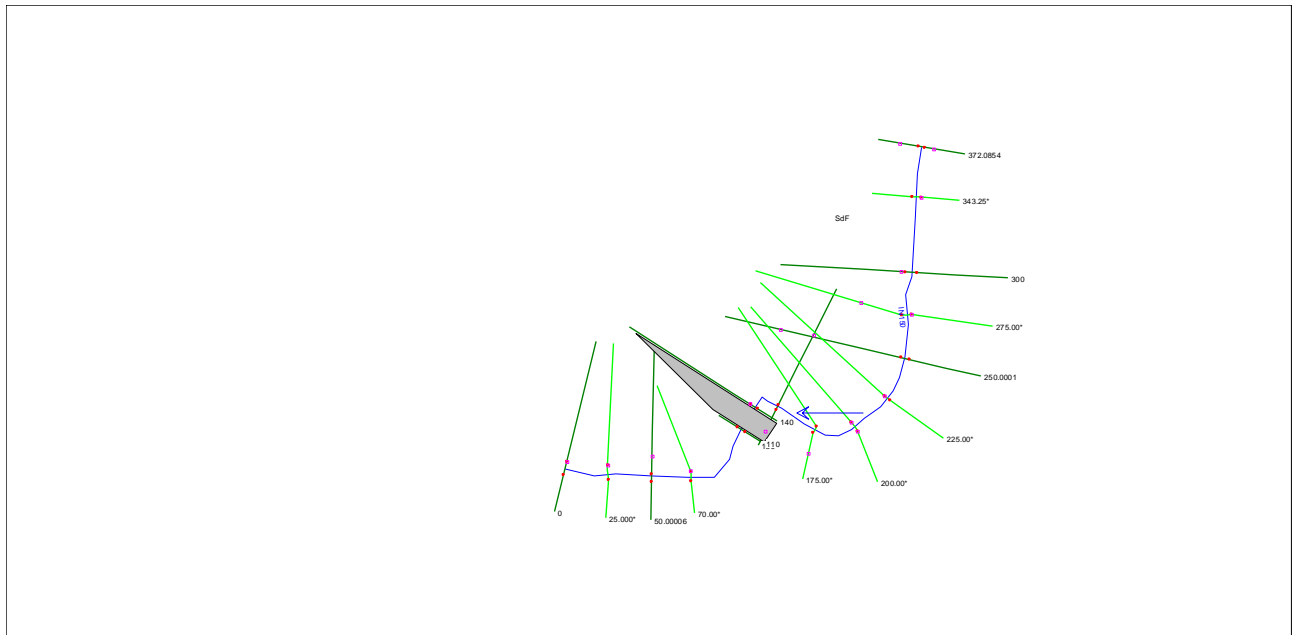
Planimetria modello 1D – stato di fatto interferenza IN150.
